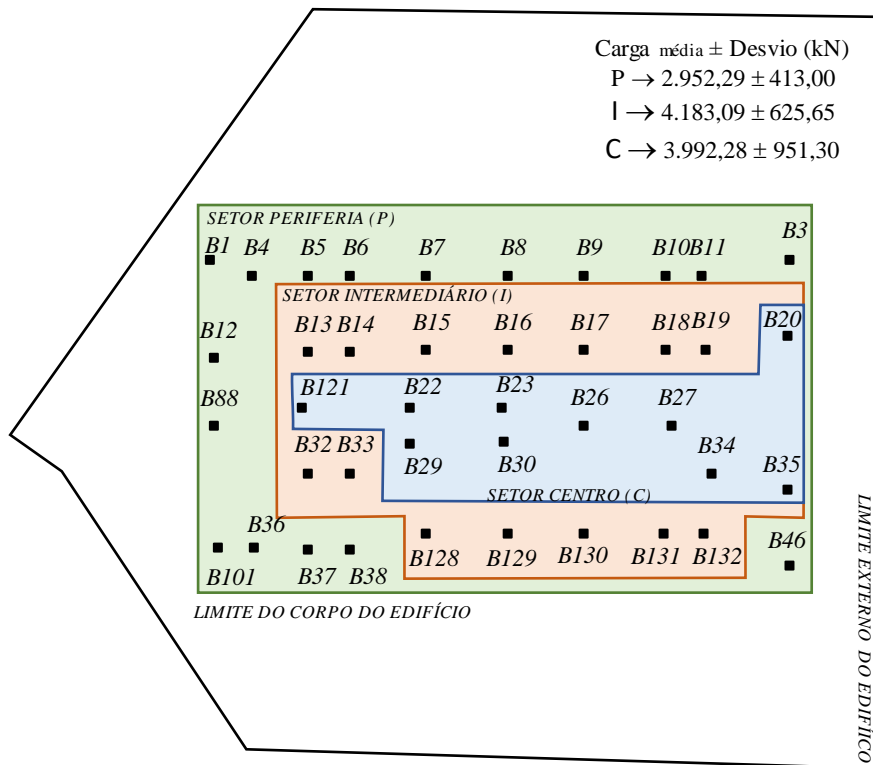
Planta dos pilares térreo do edifício e setorização segundo carregamento médio
